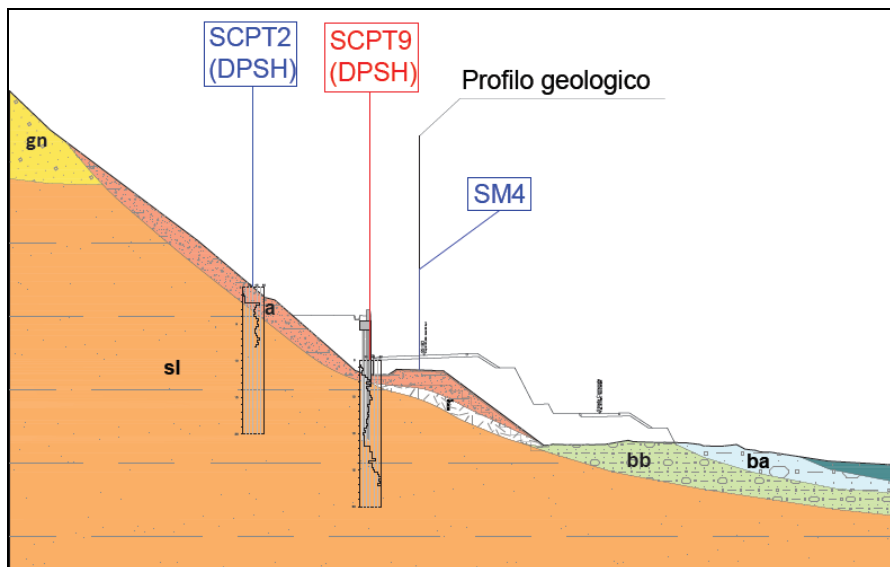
Stralcio della sezione geologica A-B con indicazione delle opere in oggetto
